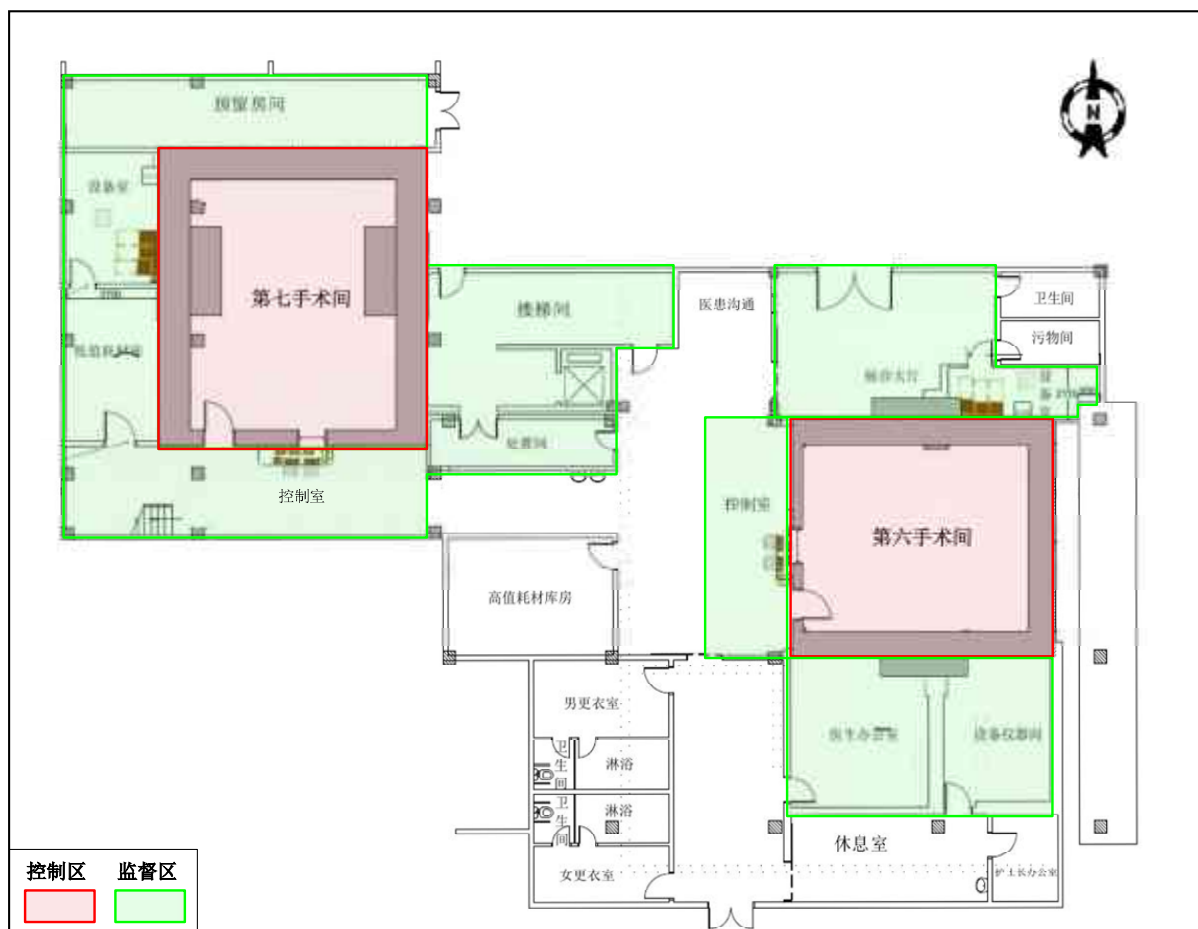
10 号楼一层介入诊疗中心 DSA 机房平面布置及分区示意图
